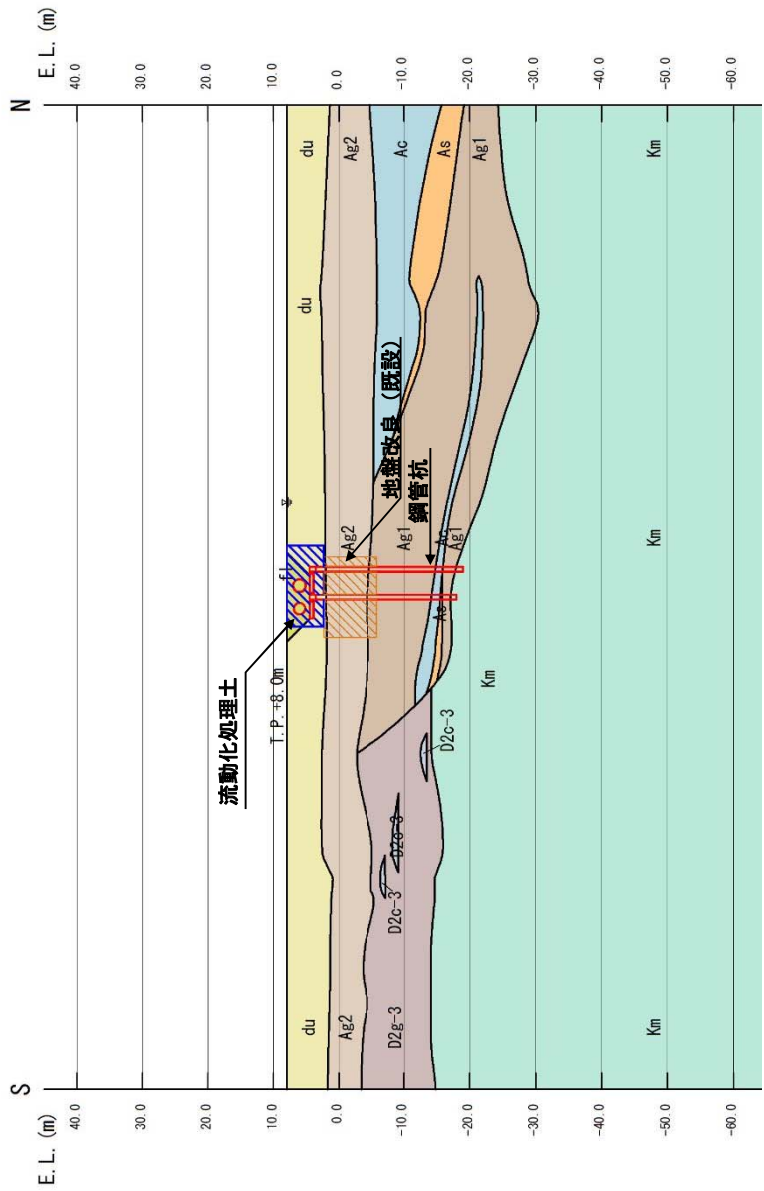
(3) 屋外二重管の横断面図 (C-C断面・杭基礎部) (区間Ⅱ 断面⑥)
